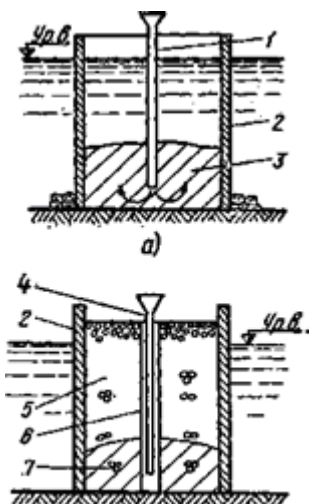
Схема подводного бетонирования методом вертикально перемещающейся трубы (а) и восходящего раствора (б): 1 — вертикально перемещающаяся труба, 2 — опалубка, 3 — уложенная бетонная смесь, 4 — труба, подающая раствор, 5—каменная наброска, 6 — предохранительная шахта, 7 — наброска, заполненная раствором
